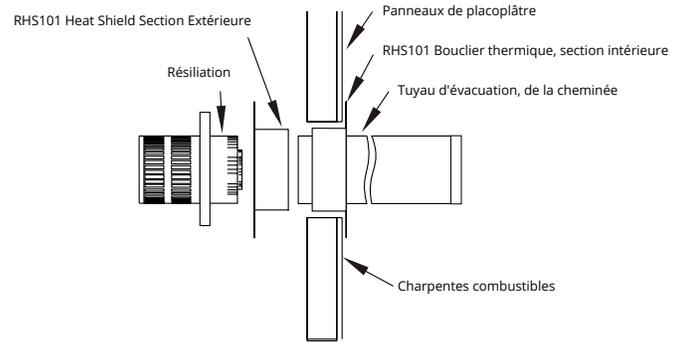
Installation du RHS101. (Installer en faisant glisser la section extérieure sur le tuyau d'évent où elle passe à travers la construction combustible).
